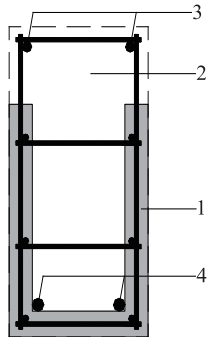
U形叠合梁下部纵向钢筋配置示意
